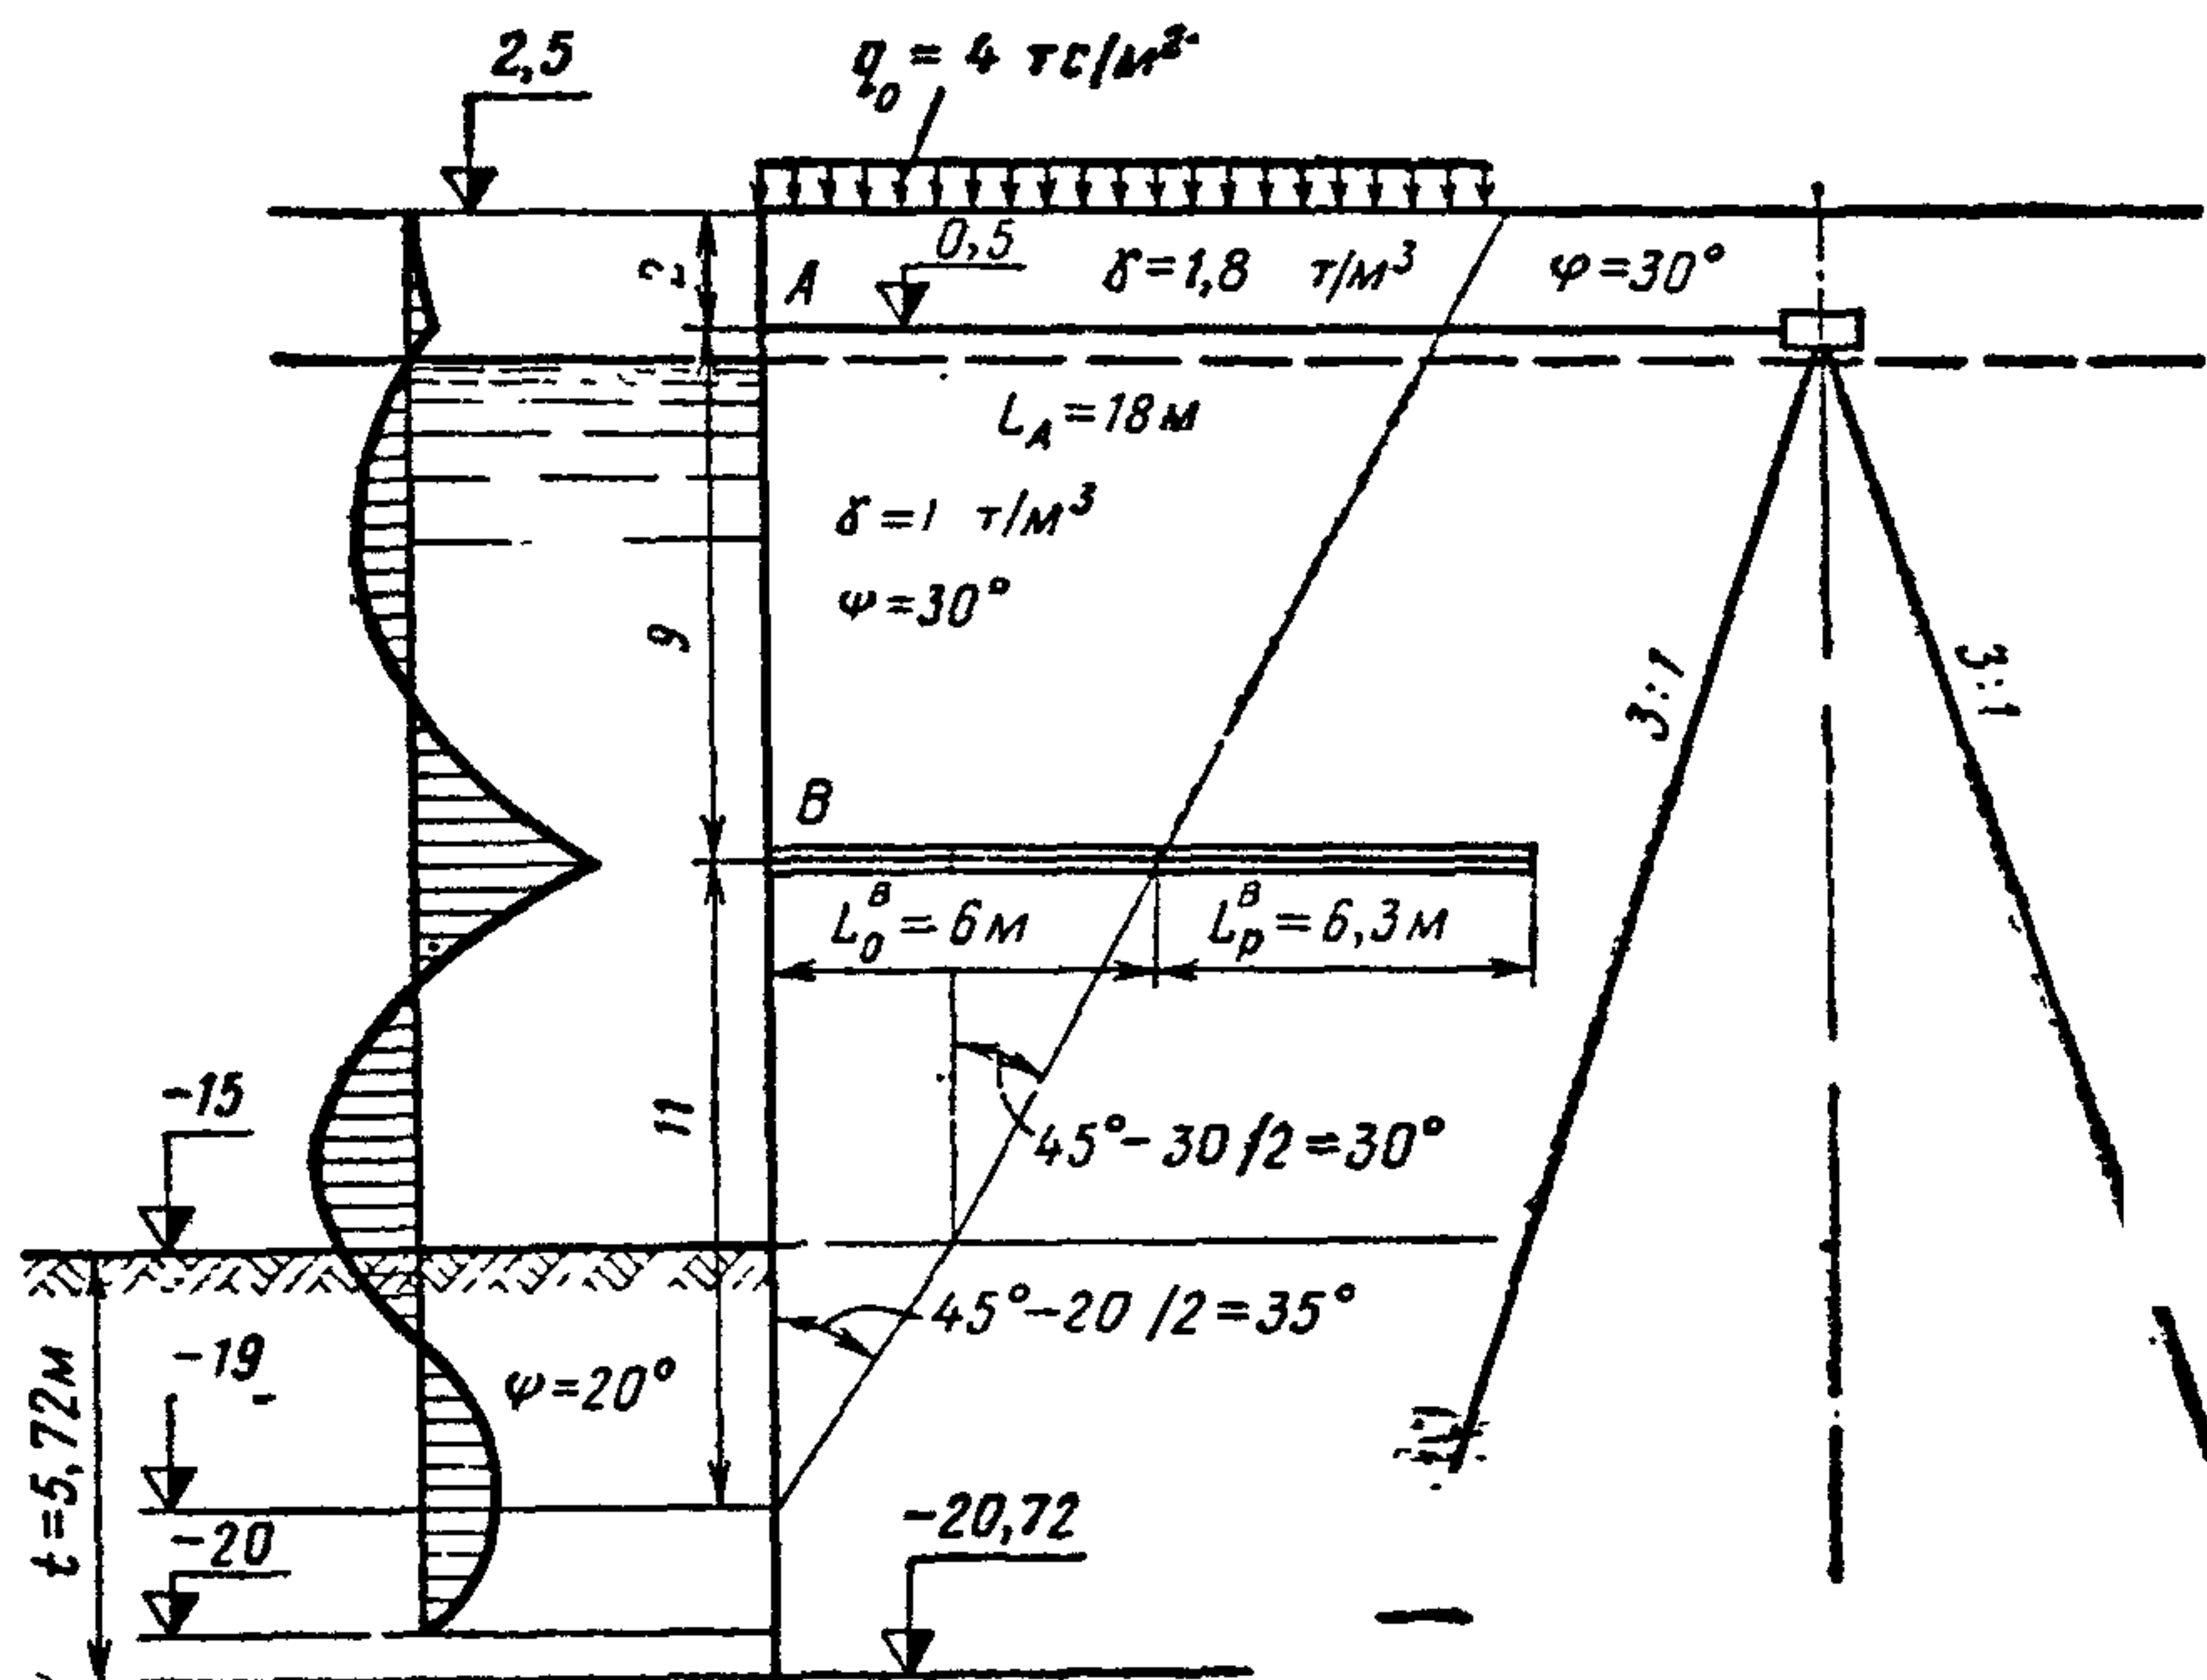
Определение длины анкеров при расчете шпунтовой стенки с анкеркой на двух уровнях
